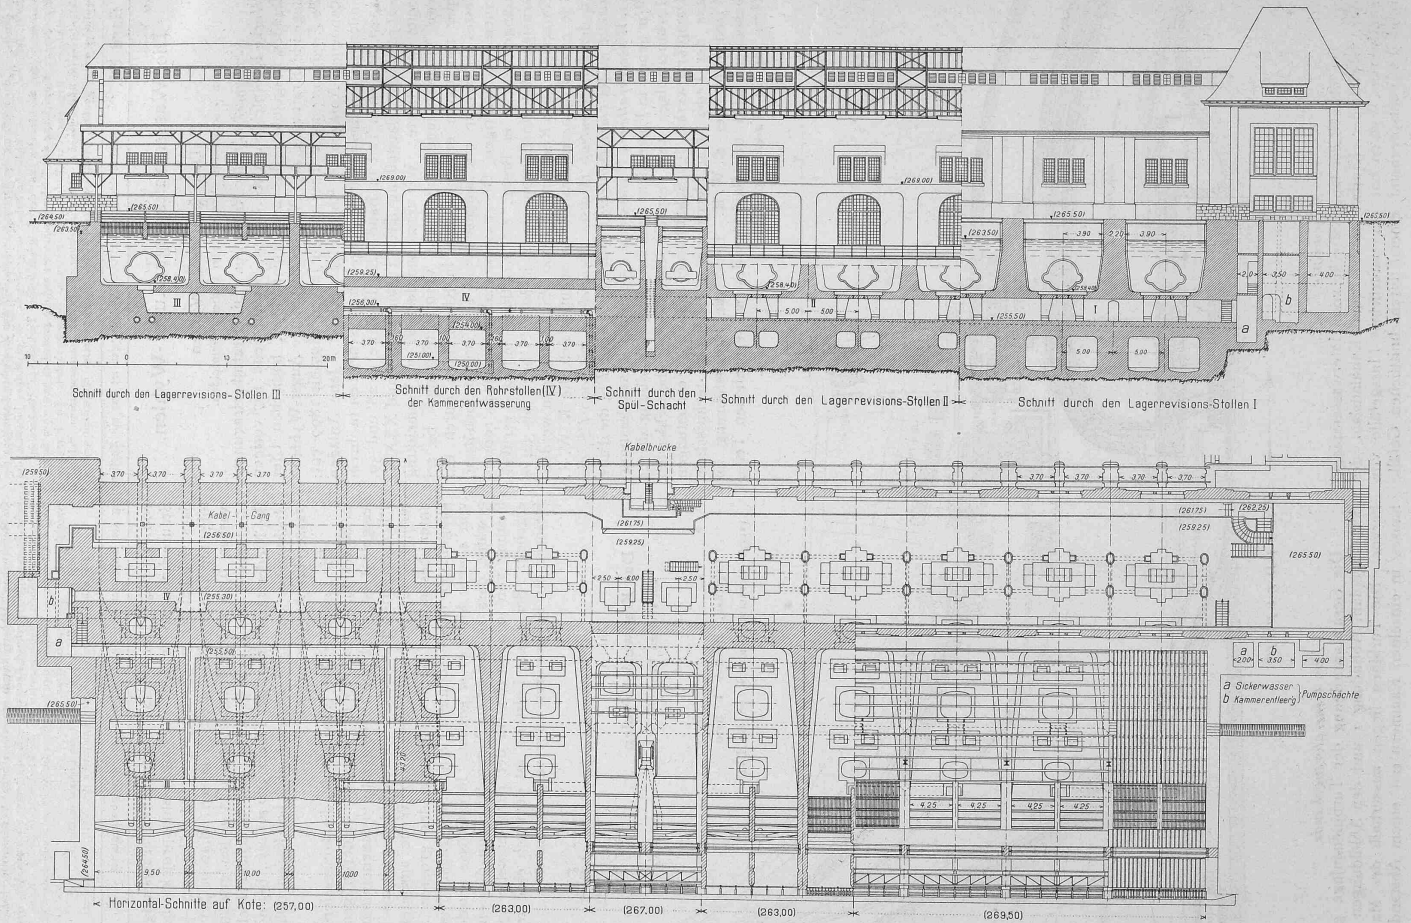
Grundriss, bzw. Horizontalschnitte, und Abb. 4: Vertikale Längsschnitte des Generatorengebäudes im Wasserkraftwerk Wyhlen. — Masstab 1 : 500.
